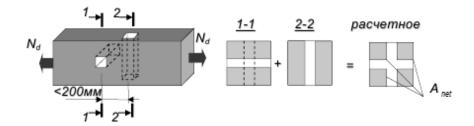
Расчетное сечение элемента (к решению примера)
